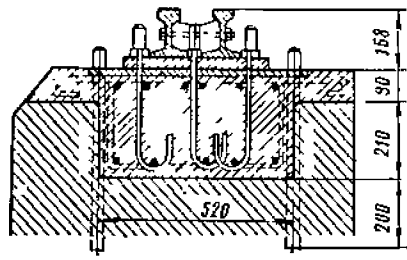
Подкрановый путь из двояных рельсов на фундаментной балке
